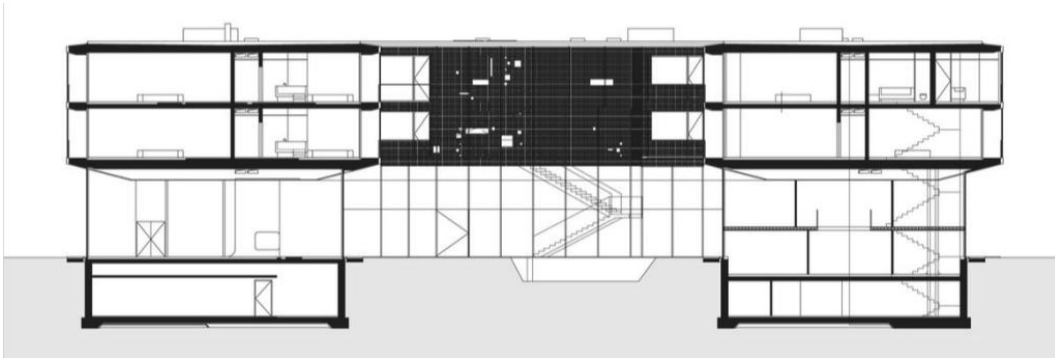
Corte transversal, acedido Outubro 17, 2014, em <http://www.archdaily.com/5524/loisium-hotel-steven-holl/>
